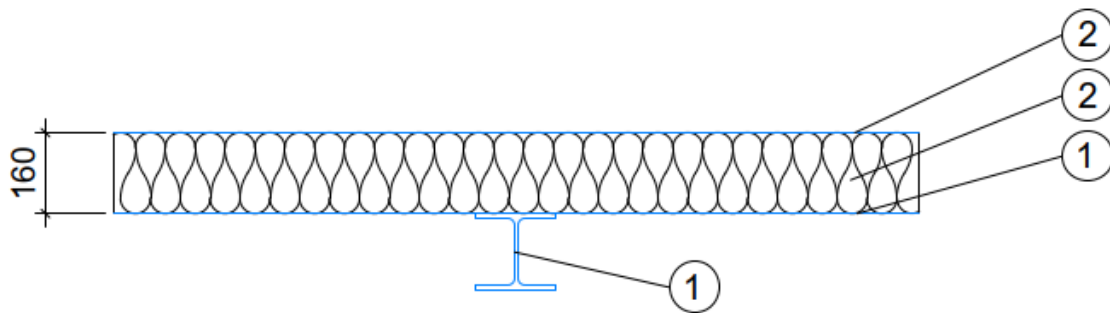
Stahlleichtbaufassade mit Sandwichelement
